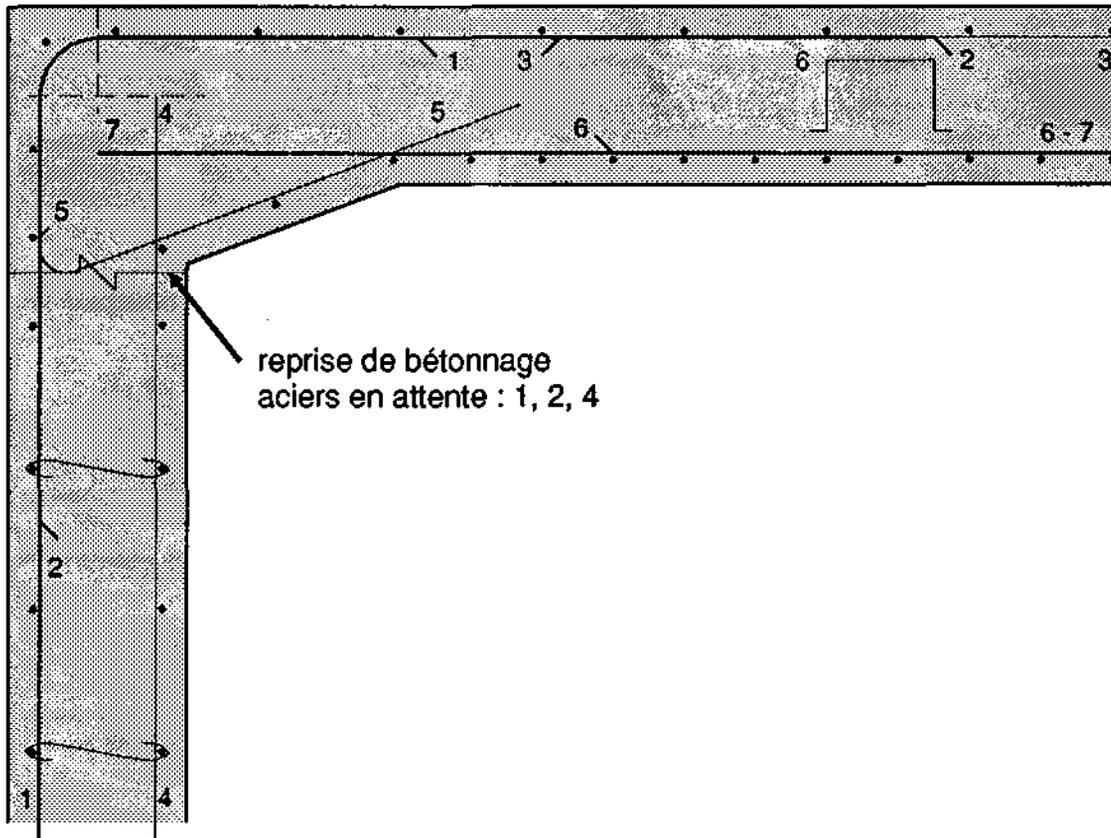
Exemple de ferrailage d'un angle supérieur
